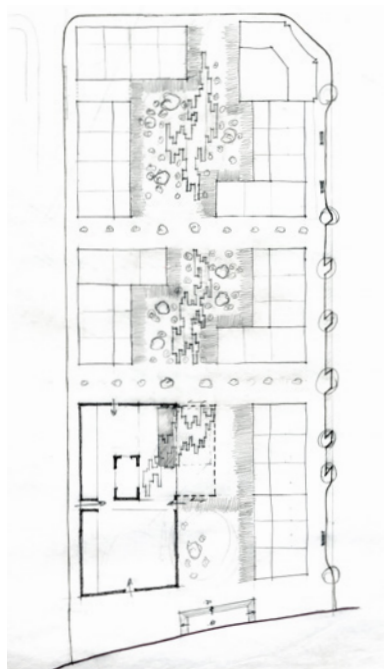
Planta de implantação do mercado e restaurantes na área de Entrecampos.
